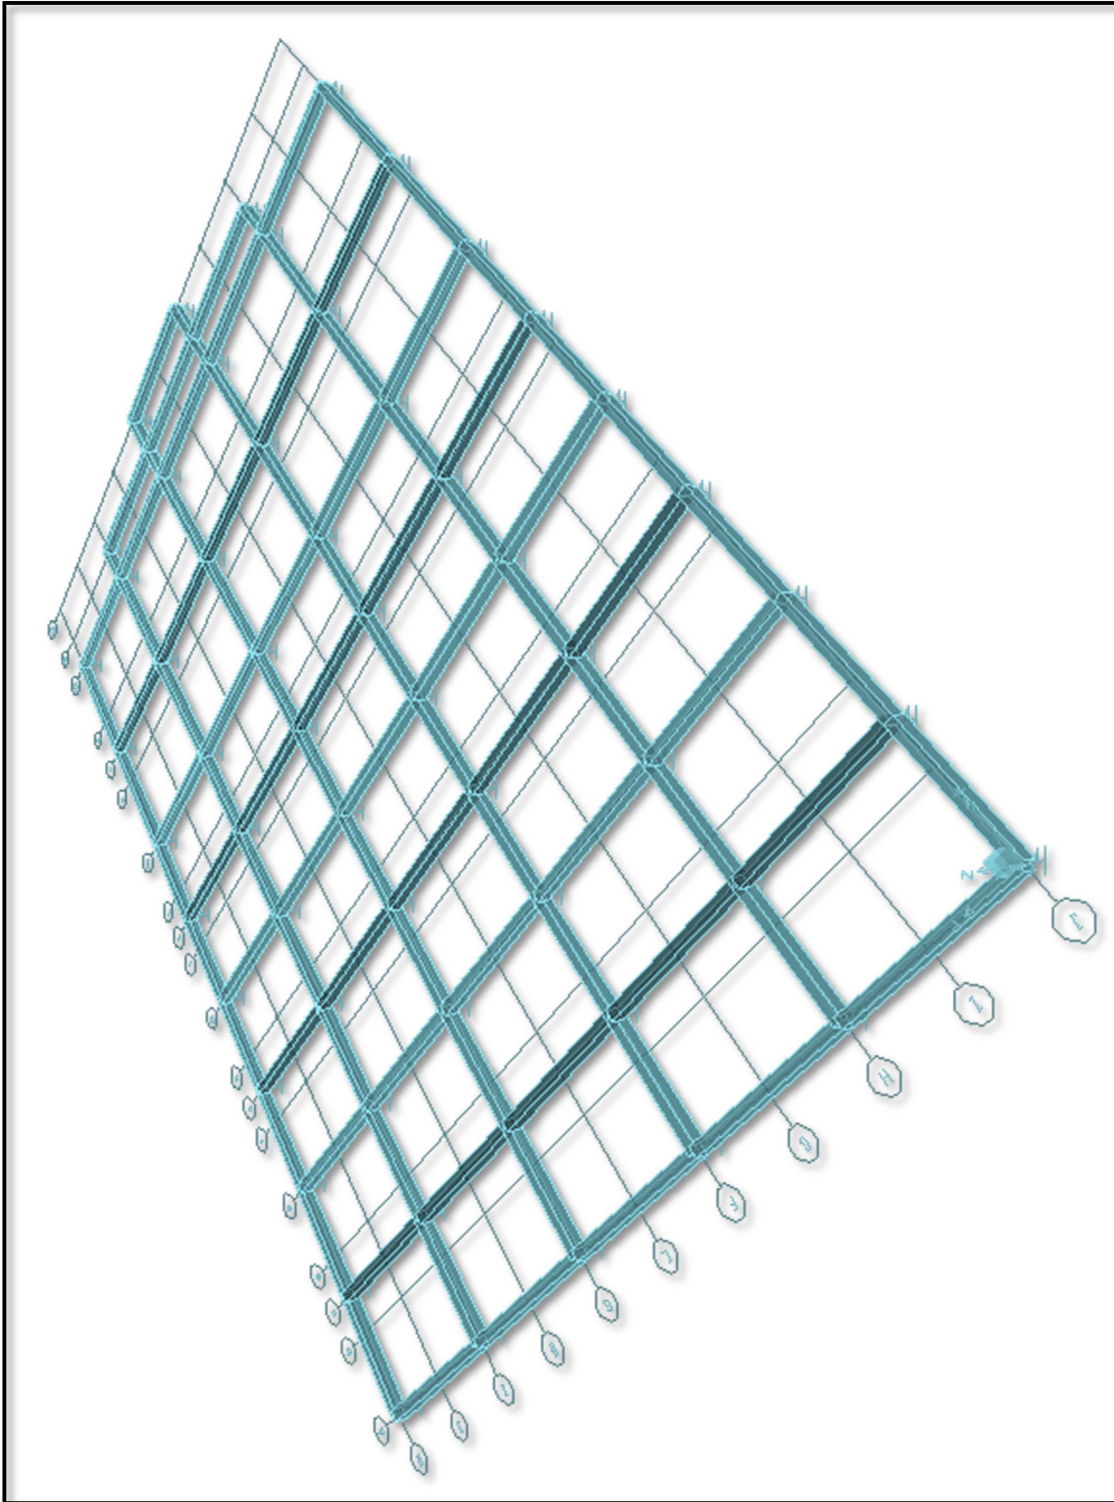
7 Vista extruida de la retícula de cimentación. Las contratraves de refuerzo están en azul fuerte.
